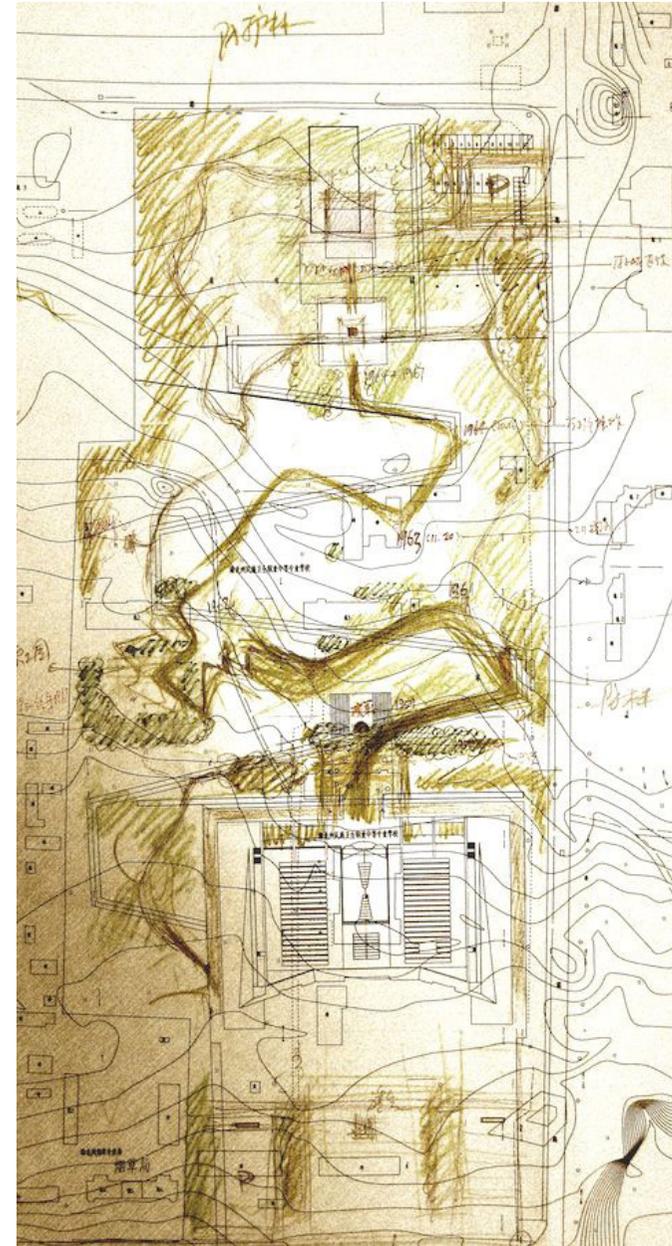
Plan 1 plan general (pintado por Zhu Yufan). (Imagen extraída en red:youthla.org)
